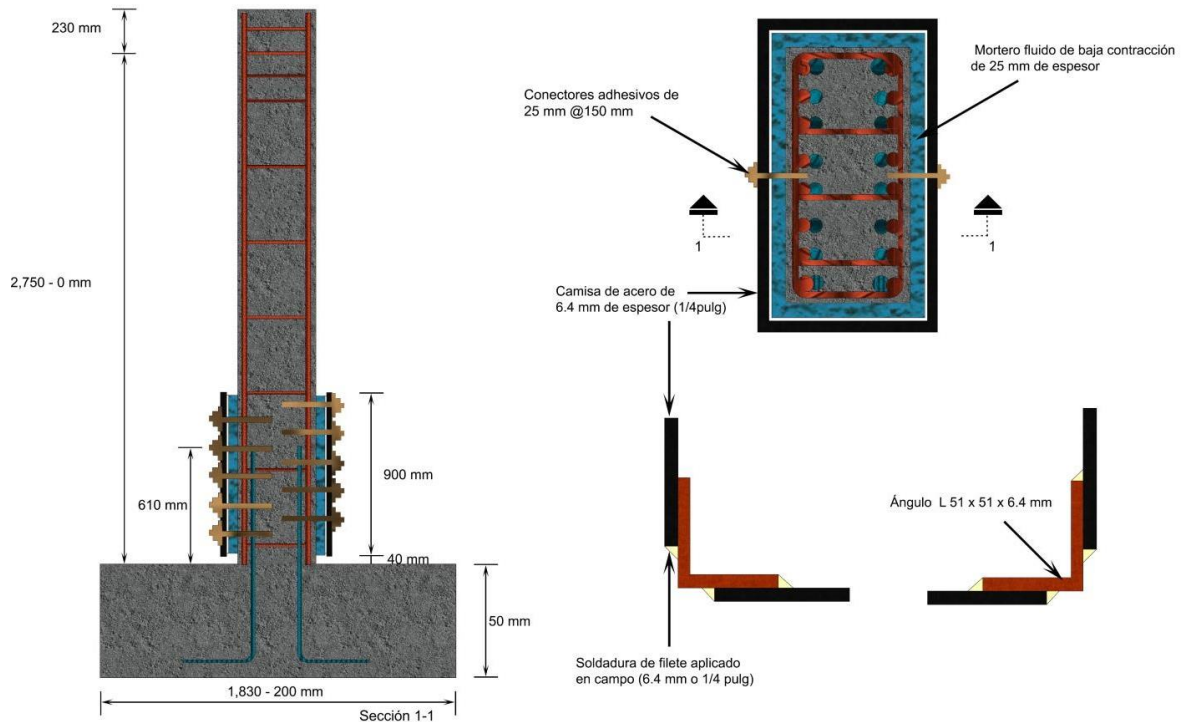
Encamisado local de una columna con longitud escasa de traslapes. Véase el detalle de soldadura de las placas del encamisado a ángulos en las esquinas. Fuente: Aboutaha, 1994.
